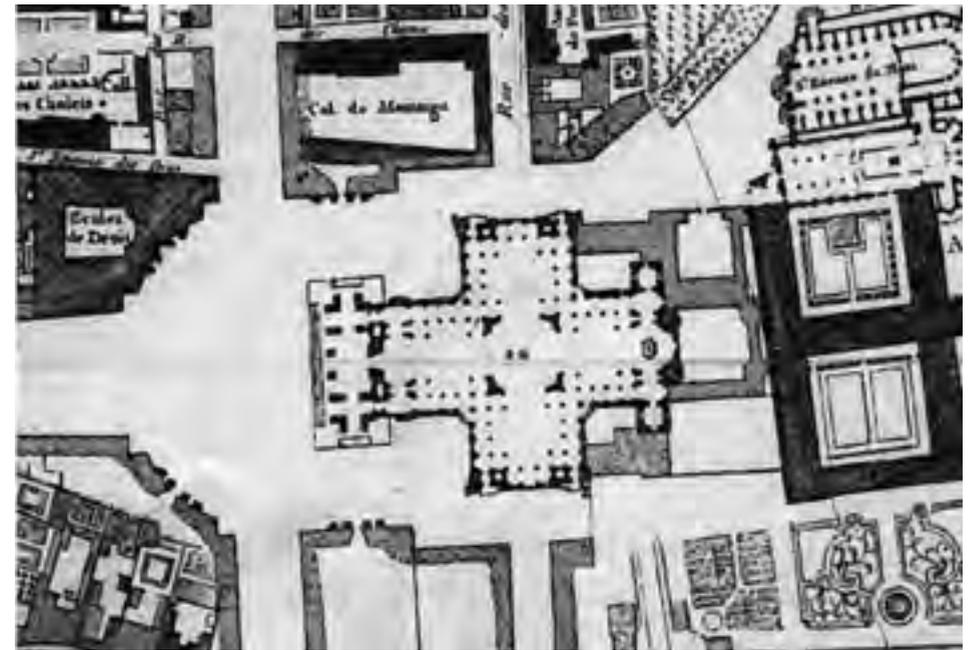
Jacques-Germain Soufflot. Planimetria dell'area di Place du Panthéon con indicate le sovrapposizioni degli edifici in progetto, 1764.
